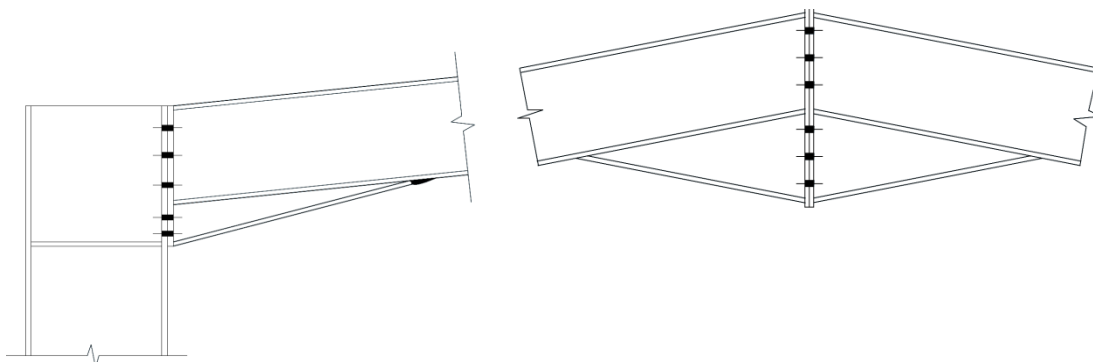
Exemplo de reforço na ligação pilar-viga e cumeeira, respetivamente (SECHALO, 2012)
